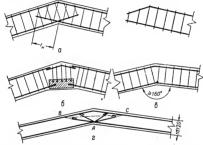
126. Армирование сварными каркасами и сетками входящих узлов железобетонных конструкций:
